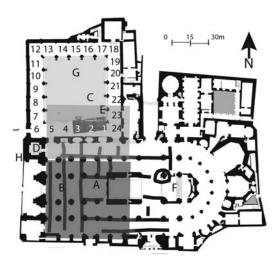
Plantas de la Mezquita aljama y la Catedral gótica: A. Planta de la mezquita. B. Cimentación de las naves. C. Patio. D. Alminar. E. Aljibe. F. Planta de la Catedral. G. Claustro. H. Torre. Tramos: 1-24
